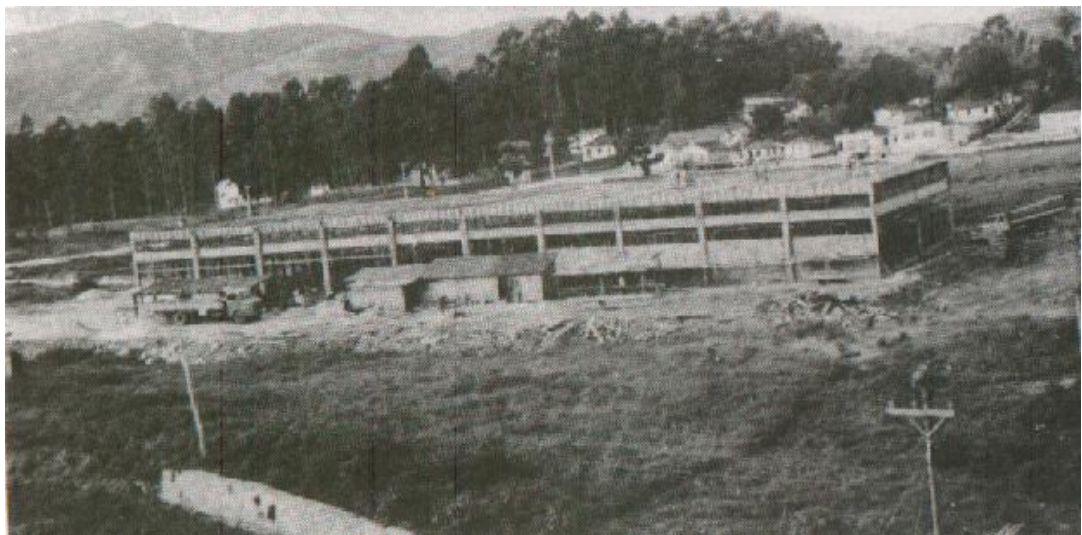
Pavilhão da Engenharia Civil em fase de construção com início em 1970.
